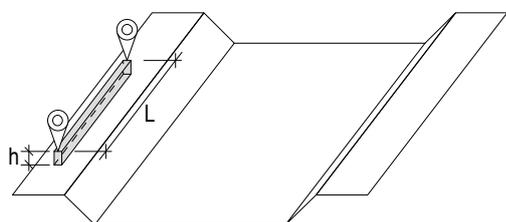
Schéma d'un mur de protection (protection contre l'inondation / l'épandage d'alluvions).
